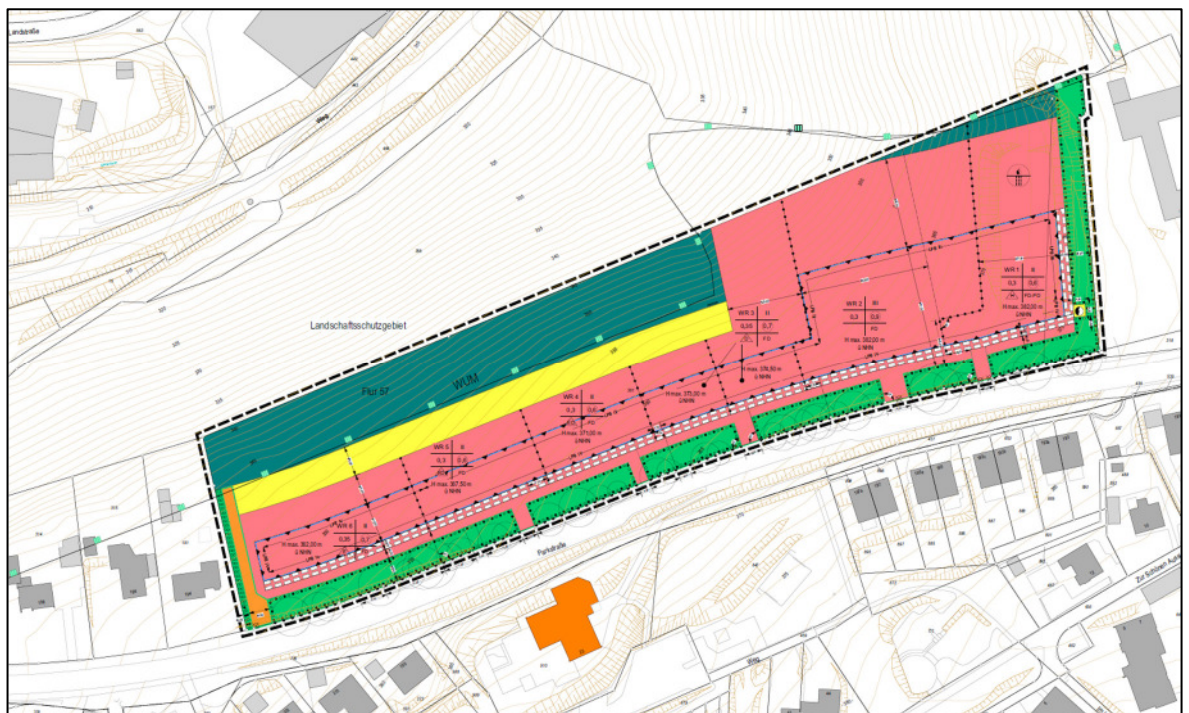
Plandarstellung des Bebauungsplans Nr. 839 "Westlich Schöneck" der Stadt Lüdenscheid
